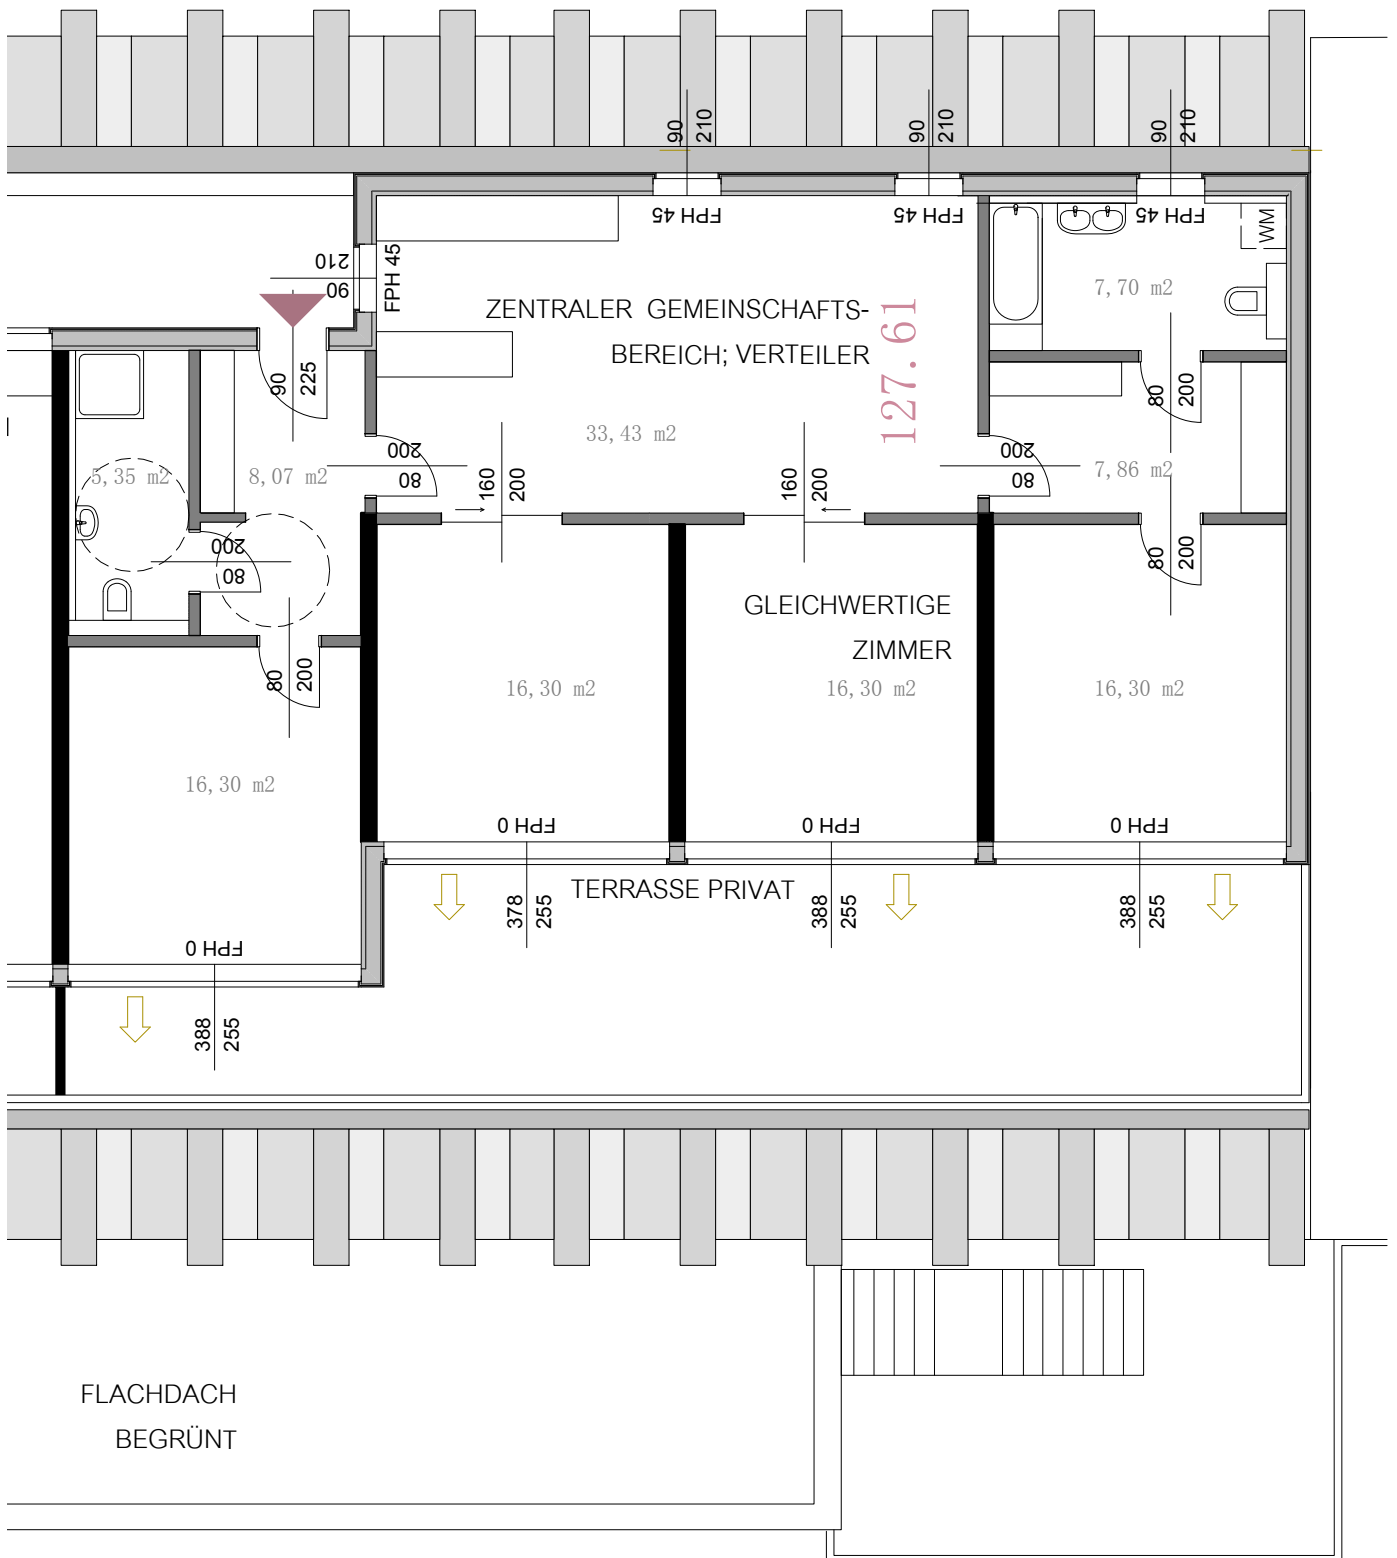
Ausschnitt Grundriss 1. Obergeschoss
